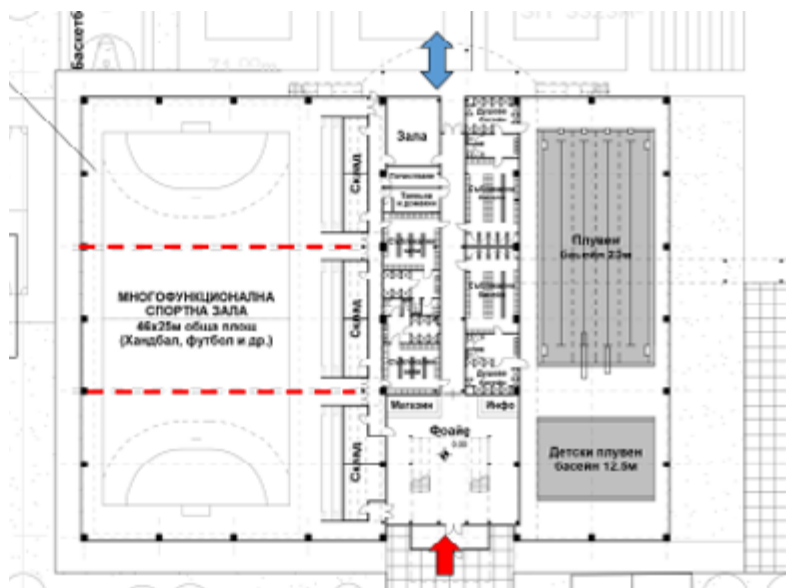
План на реконструкцията на 145-то ОУ. / Plan of the reconstruction of the 145th OU.
